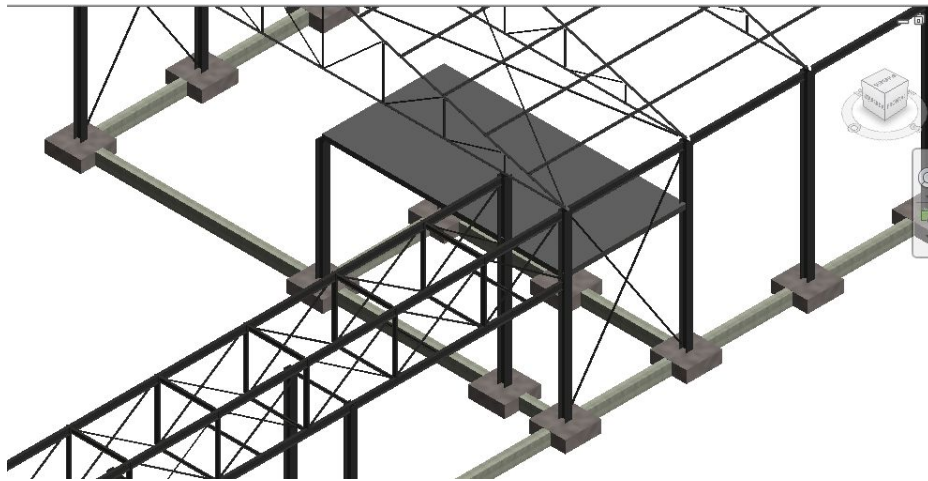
Suelo de hormigón en Planta 1 de Nave 2.
